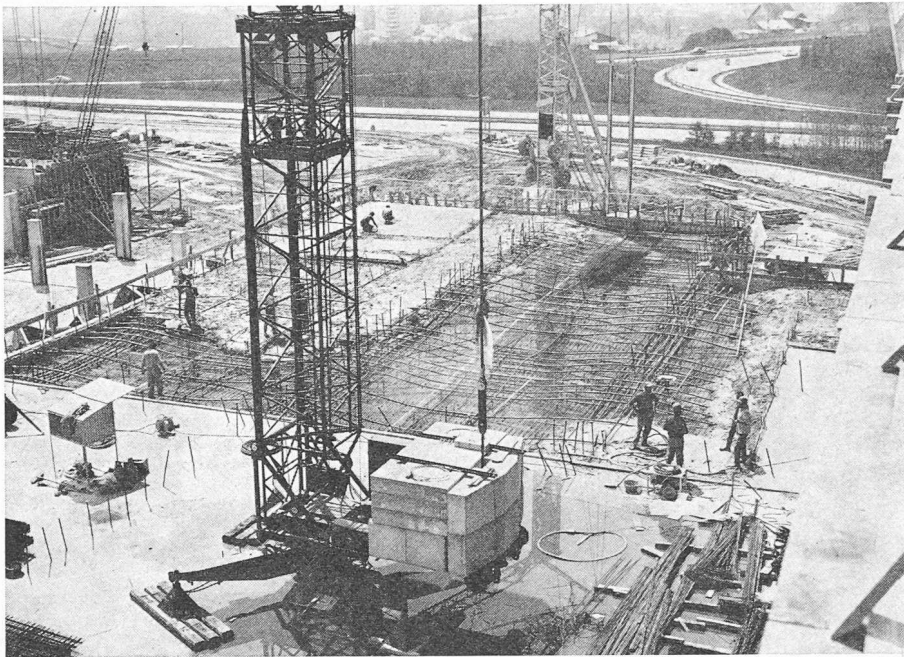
Vue générale pendant le bétonnage d'une étape de dalle sur le garage police.
